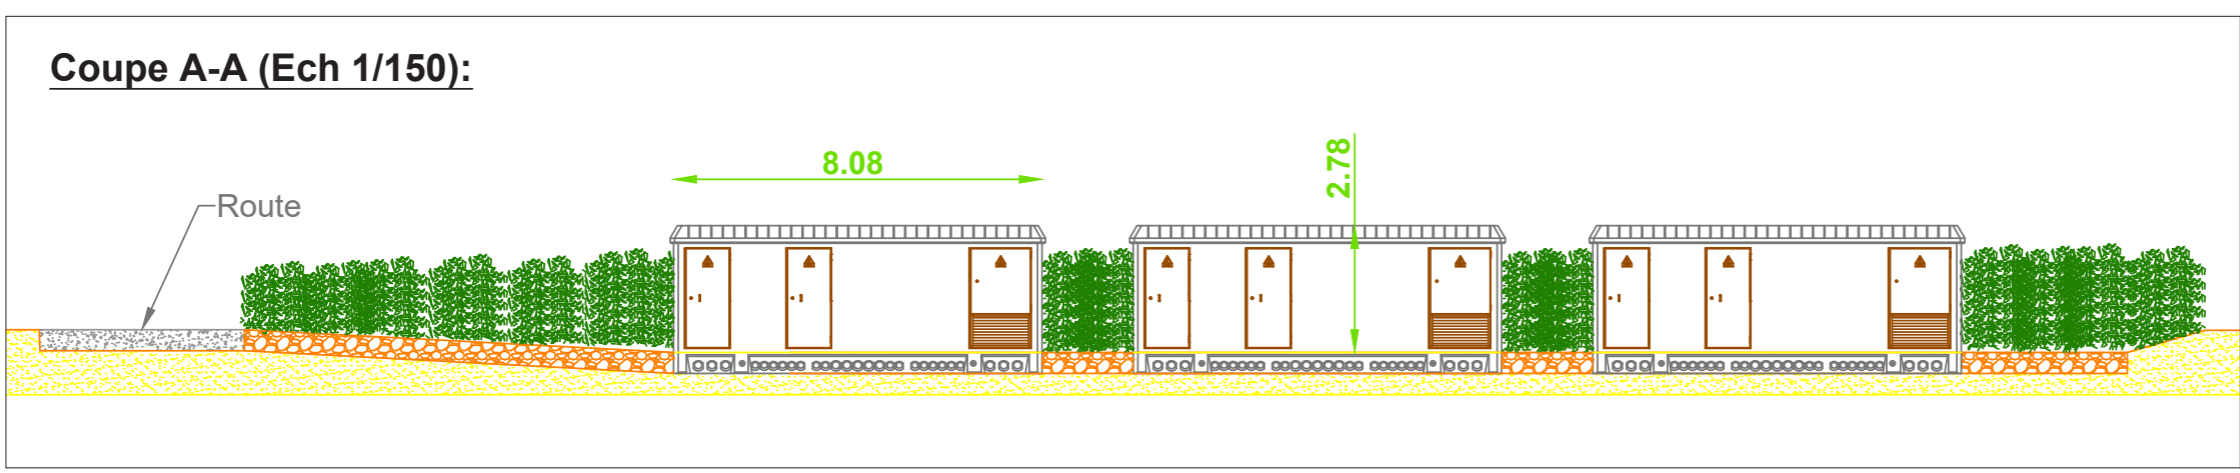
PLAN D'IMPLANTATION DES POTES DE LIVRAISON (SOURCE : ÉOLISE)
